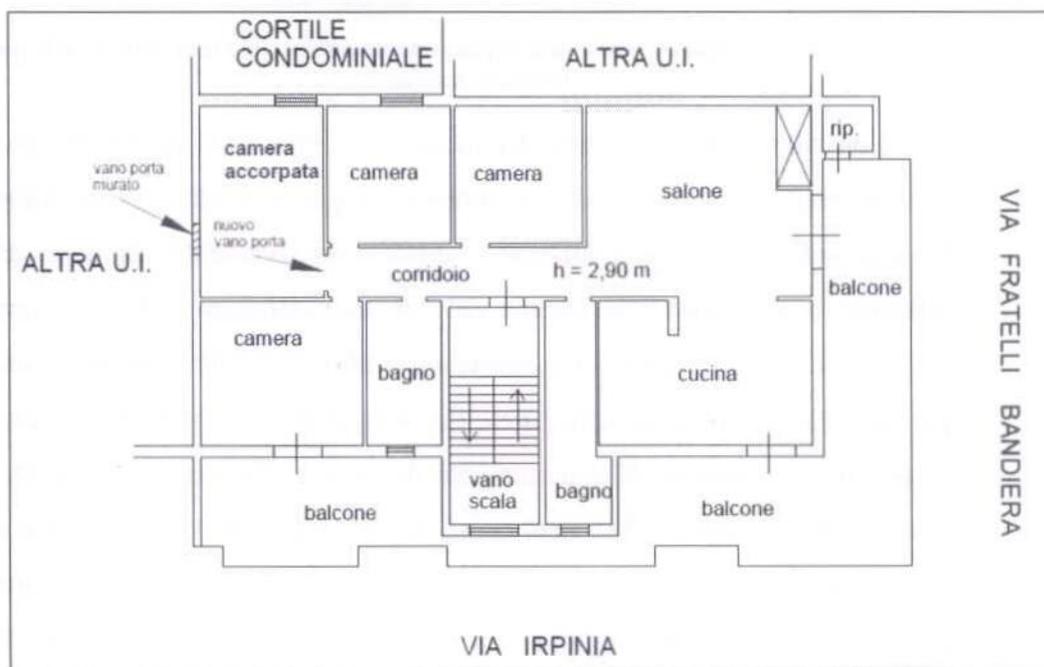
Planimetria attuale dell'appartamento ubicato in via Irpinia n° 6/B piano secondo, interno 2.
